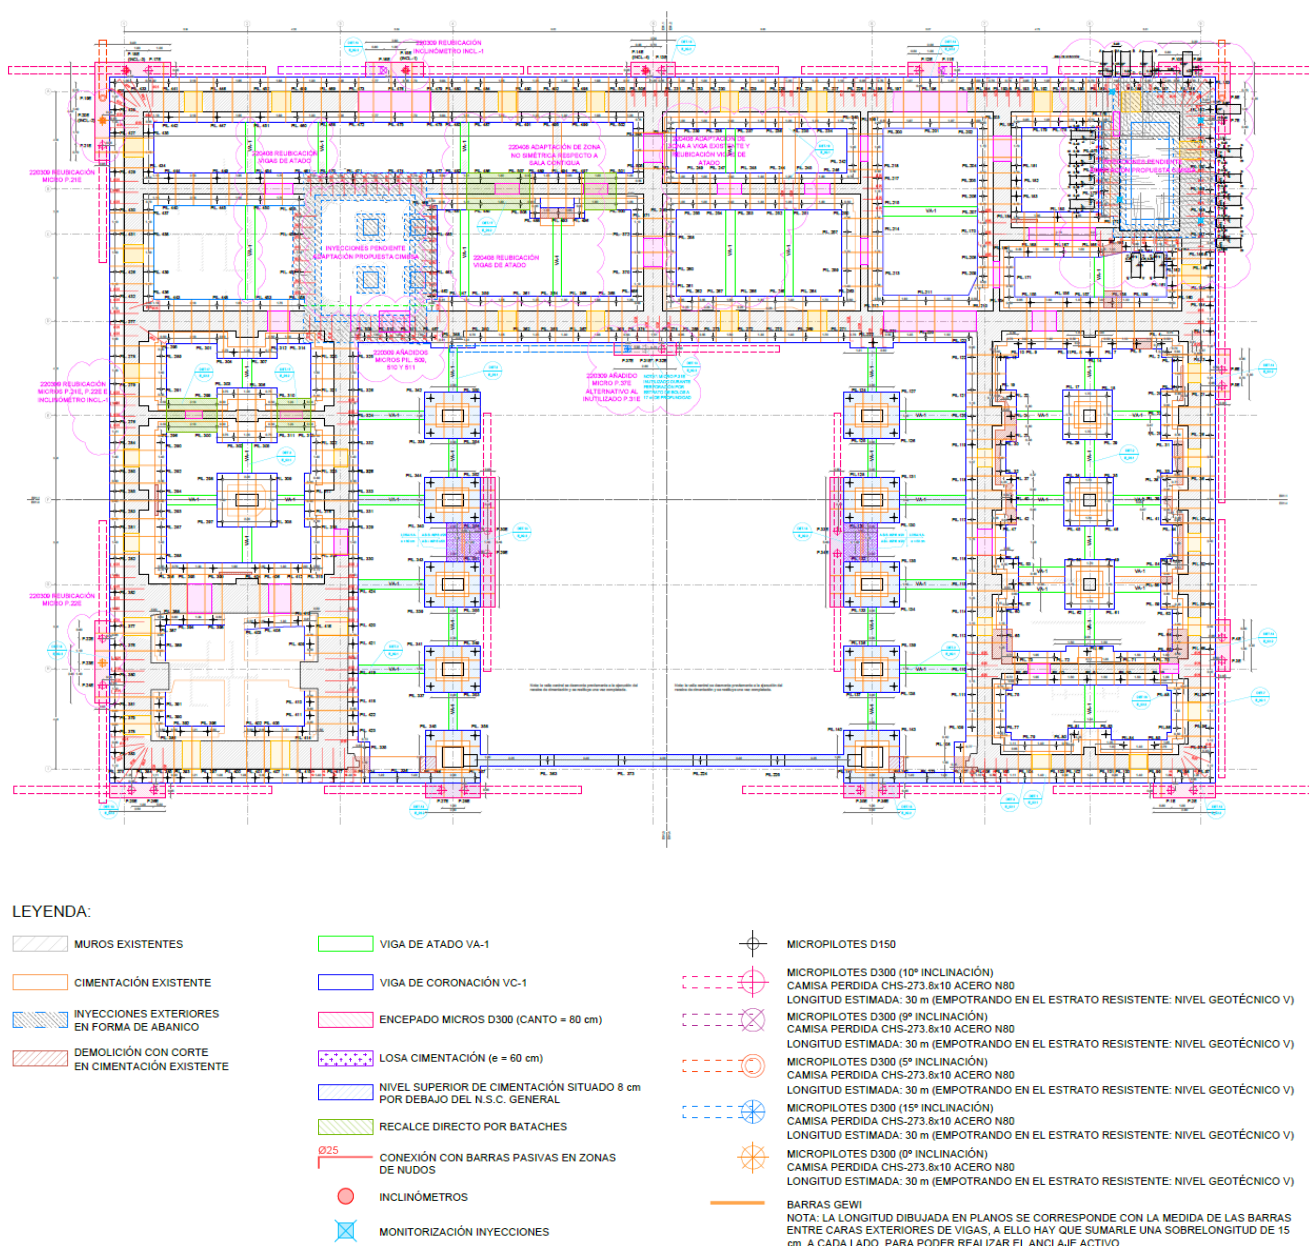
Plano de trabajo de las intervenciones de recalce de cimentación.
